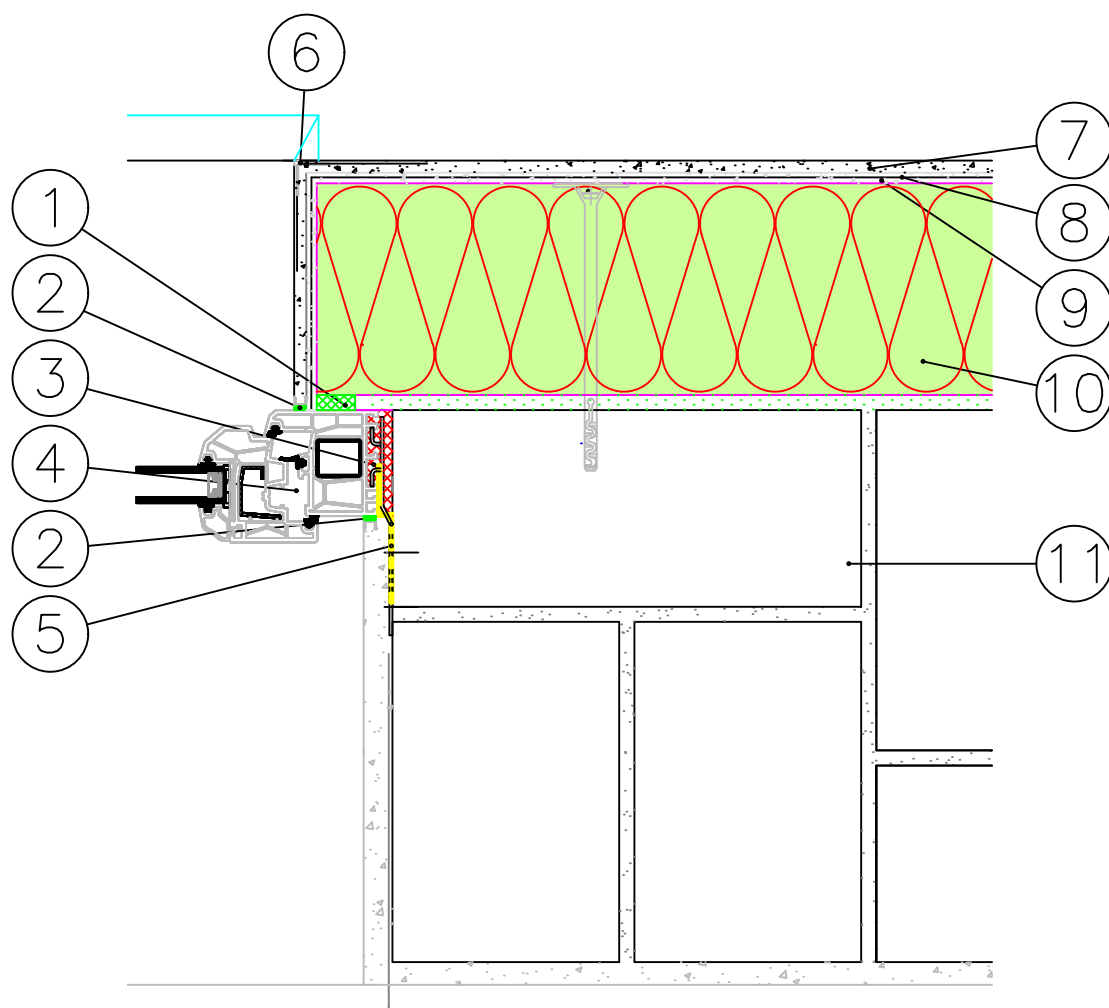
## DETAIL - PROVEDENÍ KOUTU KONTAKTNÍHO ZATEPLOVACÍHO SYSTÉMU
